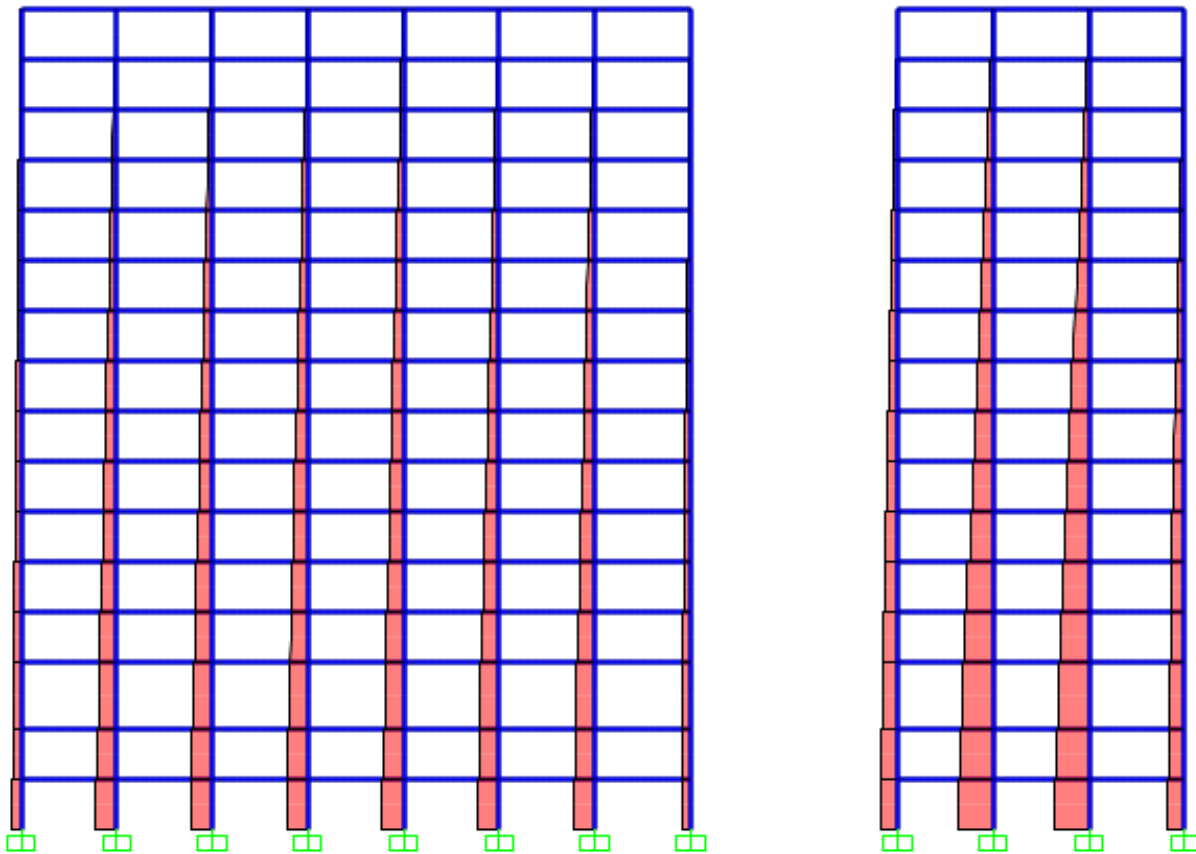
Leyes de Esfuerzos Axiales(kN) en pórtico de centro de vano.(Pórtico C,F). Comb ELU,pretensado inf.
